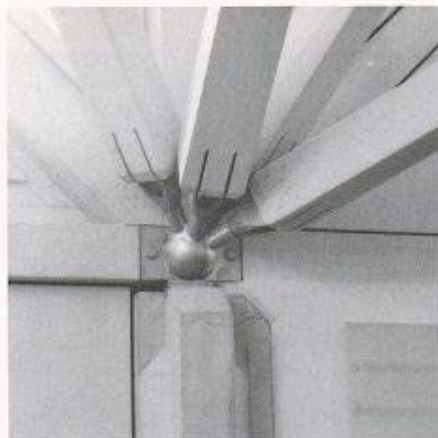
Anschluss Raumfachwerk an das ebene Fachwerk (Detail)
